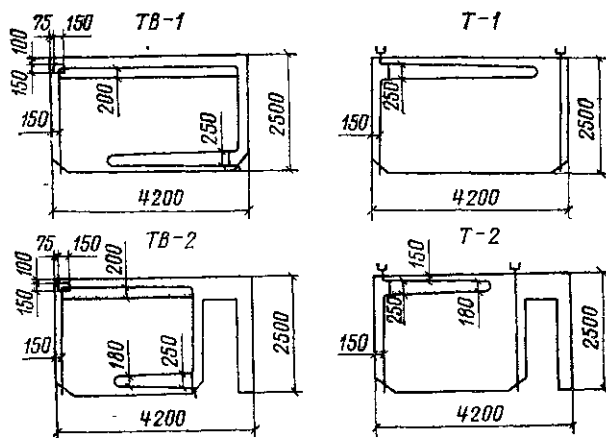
Варианты рассредоточенного размещения нагревательных элементов в бетонных стенах и перегородках
